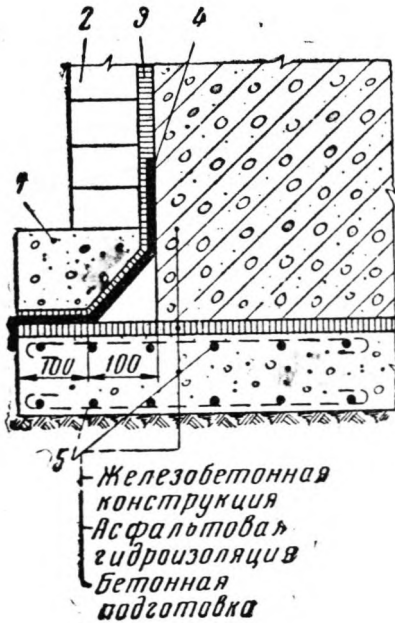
Усиление асфальтовой гидроизоляции стеклотканью в местах перехода на вертикальную стенку
